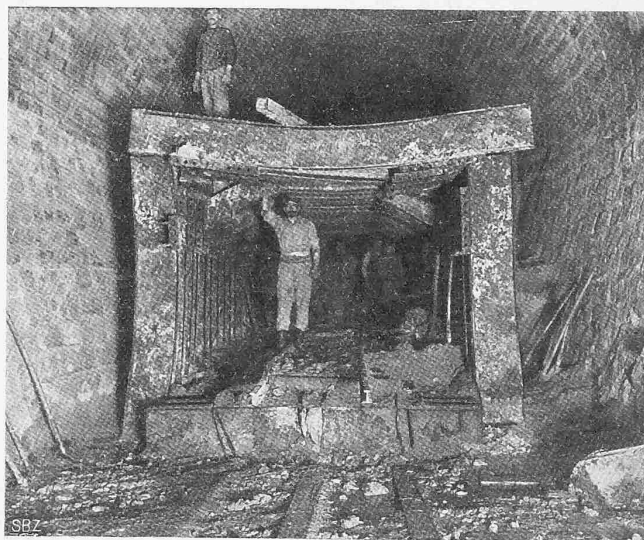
Abbruch des eisernen Stollen-Einbaues.
